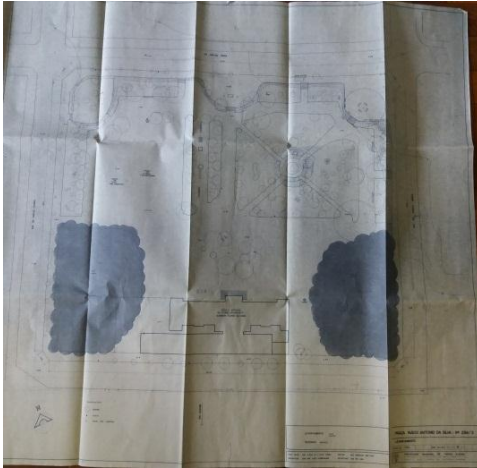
Planta baixa de levantamento da Praça Inácio Antônio da Silva (1998).
